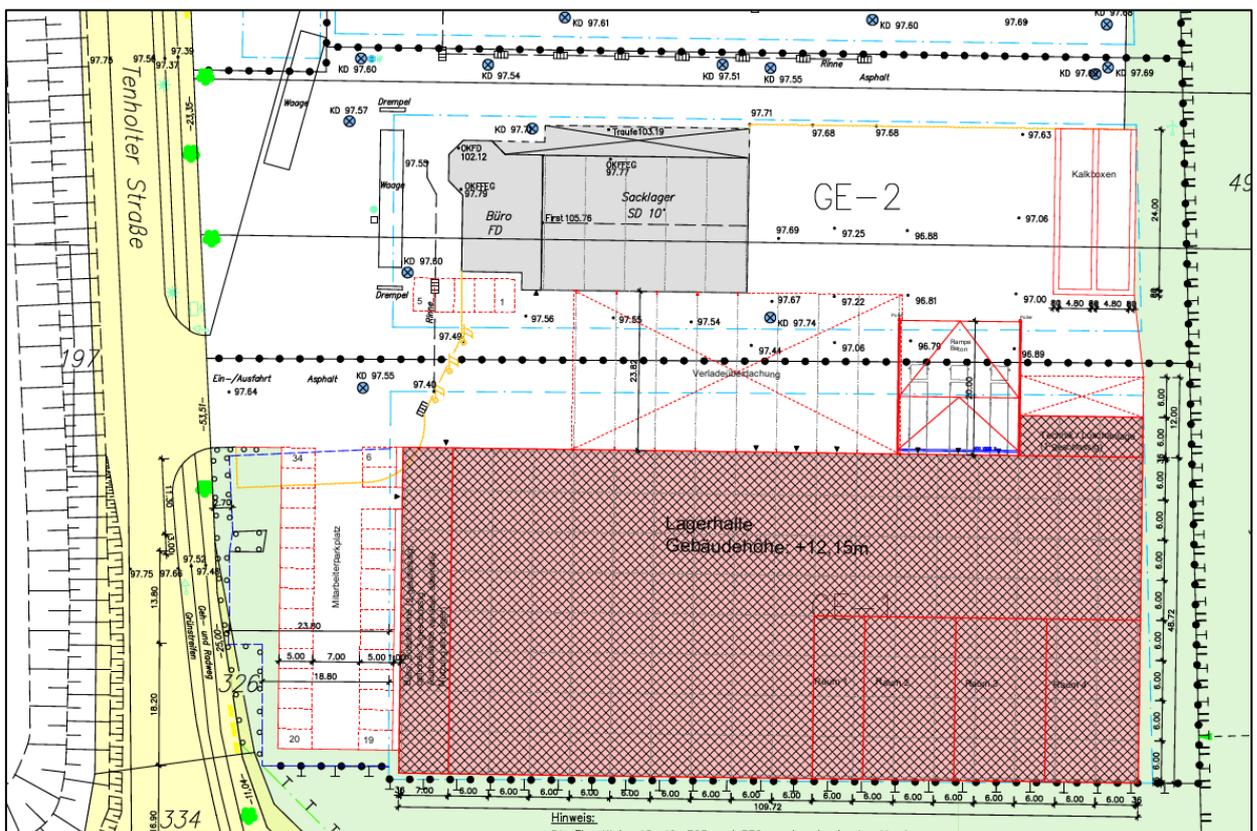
Neubau einer Lagerhalle, Lageplan (Vorentwurf), AGRAVIS Raiffeisen AG, Projektbau, Münster (Auszug), Stand: 16.06.2023
